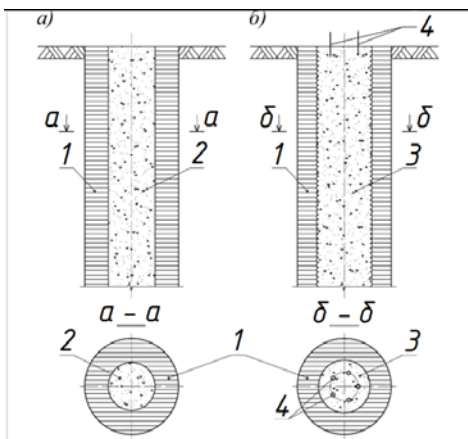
Схема устройства грунтобетонной сваи (ГБС):
